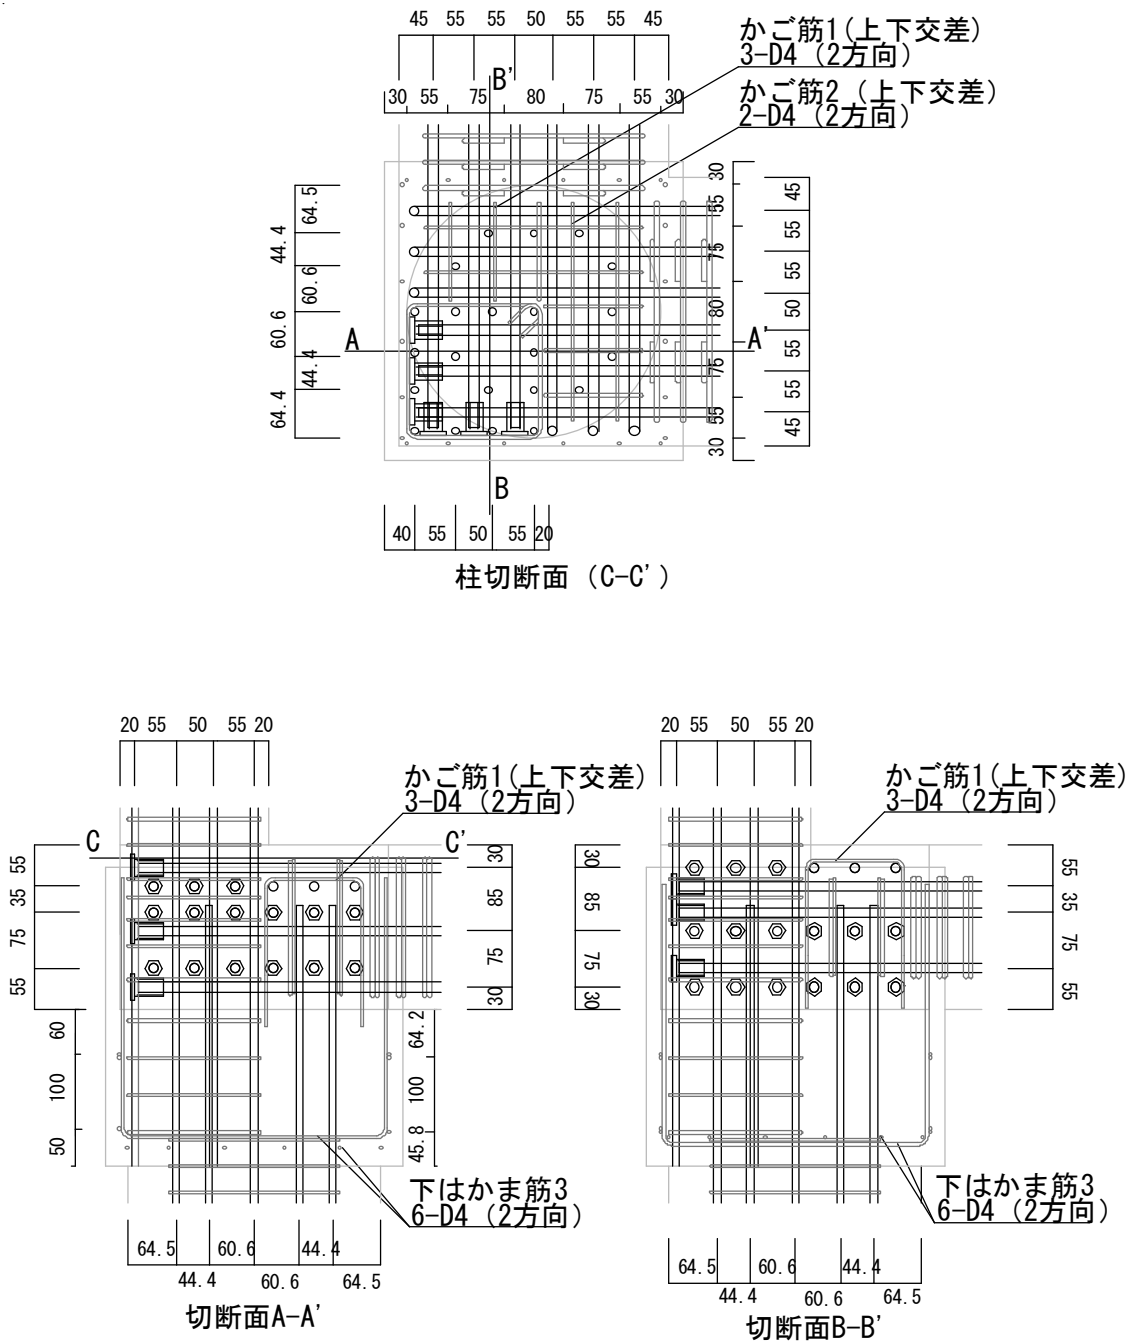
E88 試験体配筋状況 (柱切断面)
